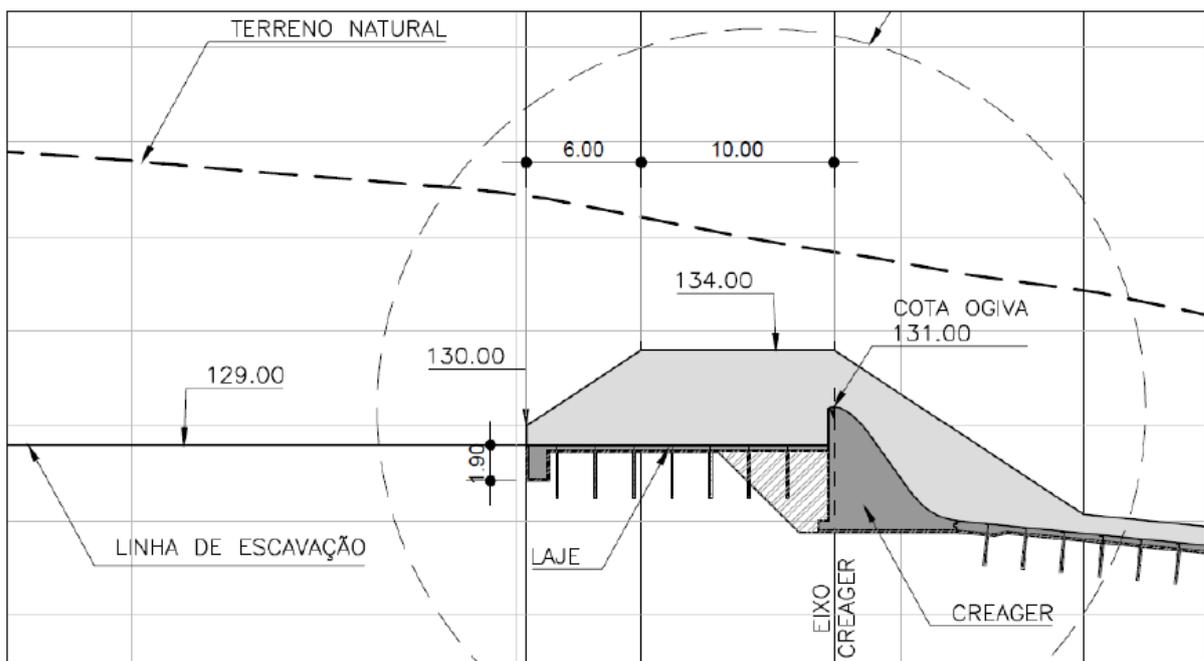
Corte Longitudinal do Vertedouro e Detalhe do Perfil Creager
